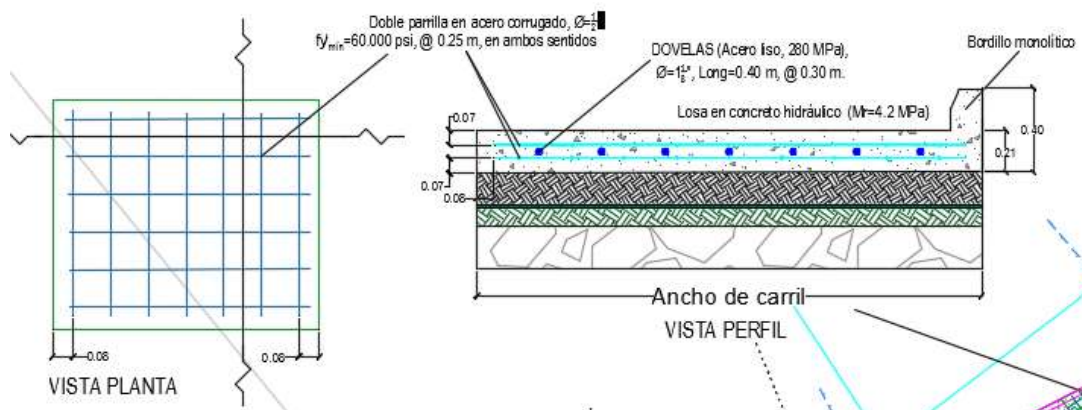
Detalle refuerzo para losa regular ($L/A < 1,30$), Brisas del Polaco.
